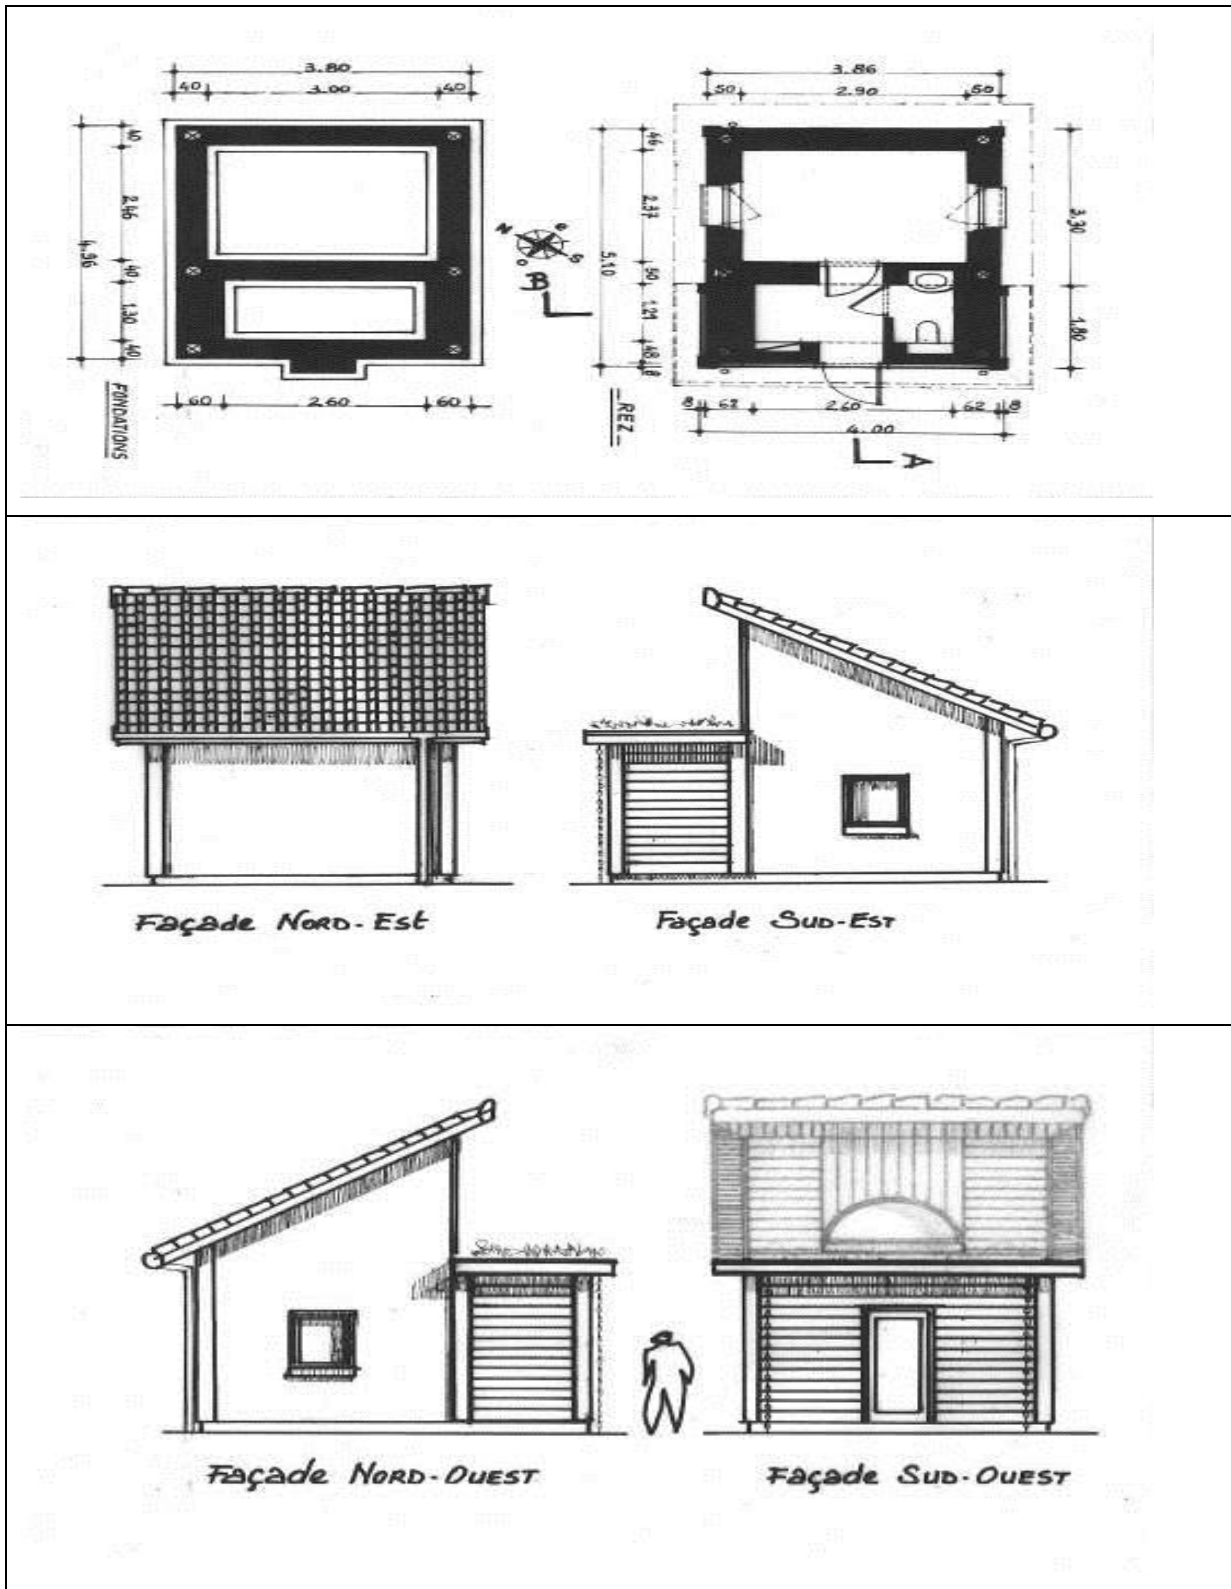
Plans du bâtiment «Terre en Nord» (Architecte : Jean-Claude D'ORAZIO)
